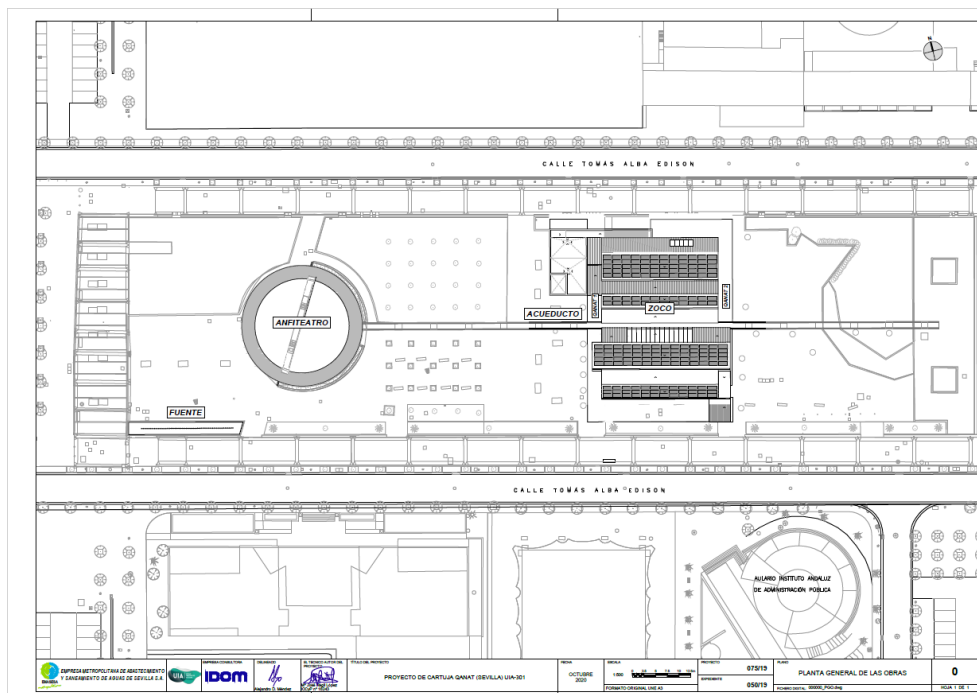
Plano general Avenida Thomas Alva Edison facilitado por IDOM
